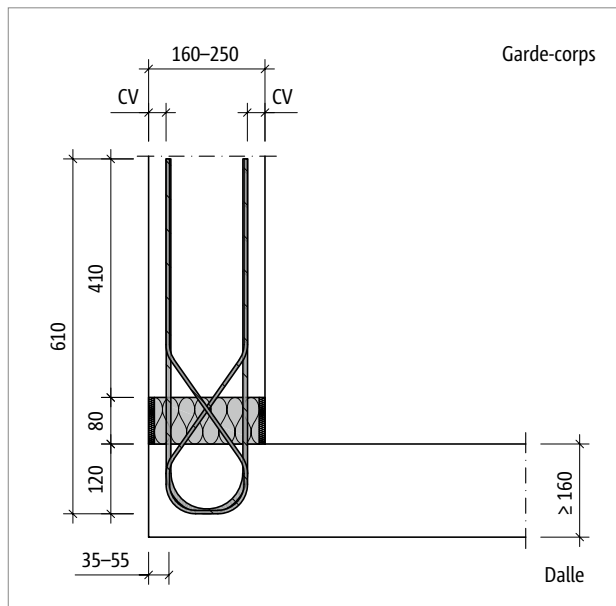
Schöck Isokorb® T type A : coupe du produit
